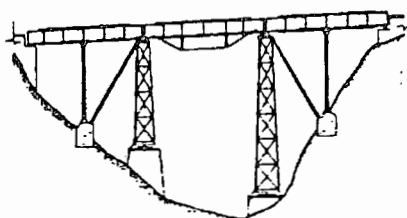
Reforço utilizado no viaduto Sinimbú, pilares intermediários e viga armada
